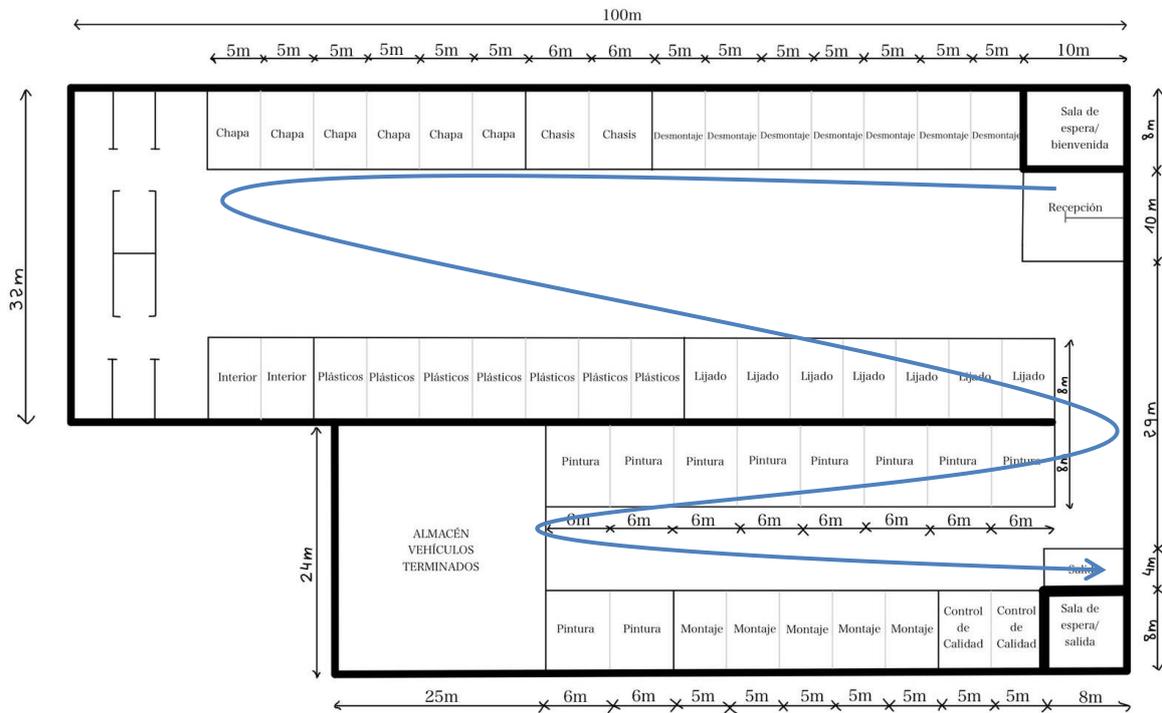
Plano en planta del taller automatizado con ruta unidireccional
